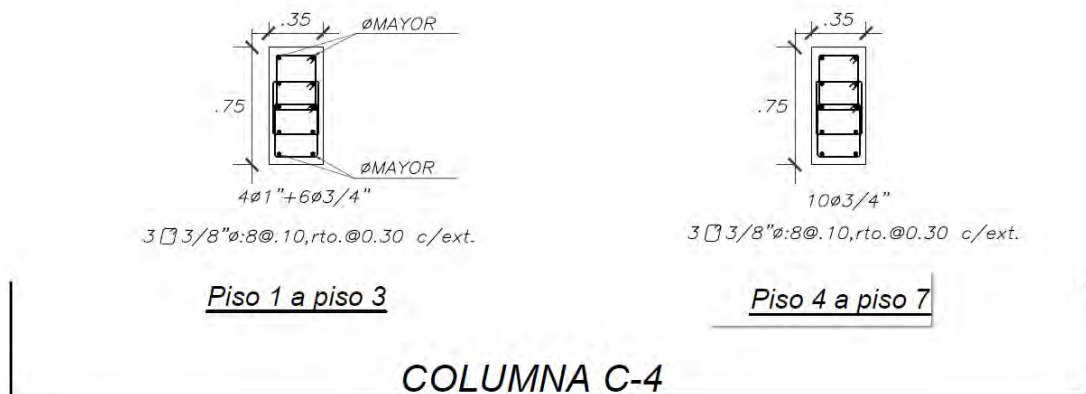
Refuerzo longitudinal y transversal de columna C-4
